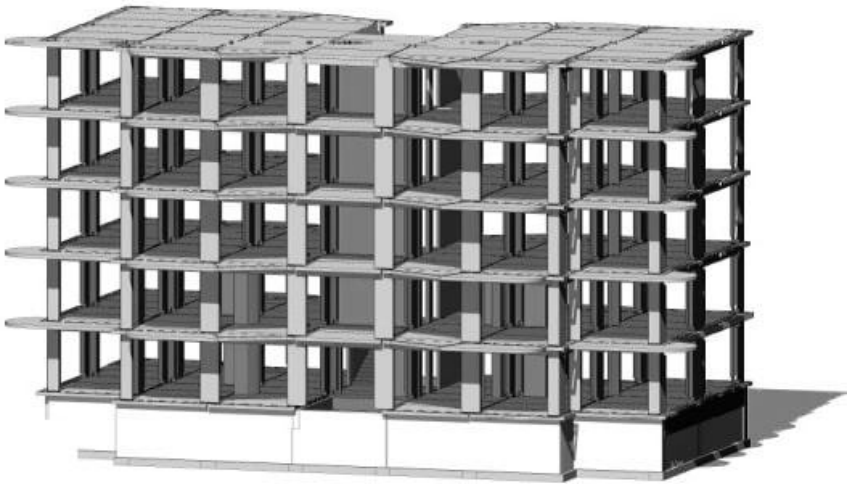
Монолітний залізобетонний каркас багатоповерхового житлового будинку.
